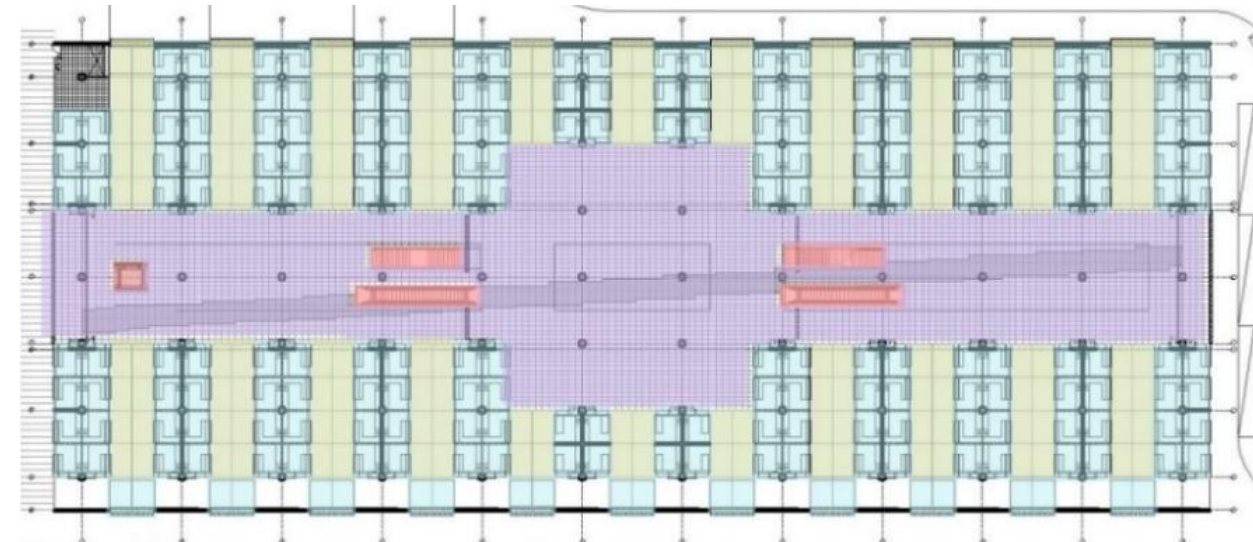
PLANTA BAJA DEL MERCADO TIRSO DE MOLINA.
